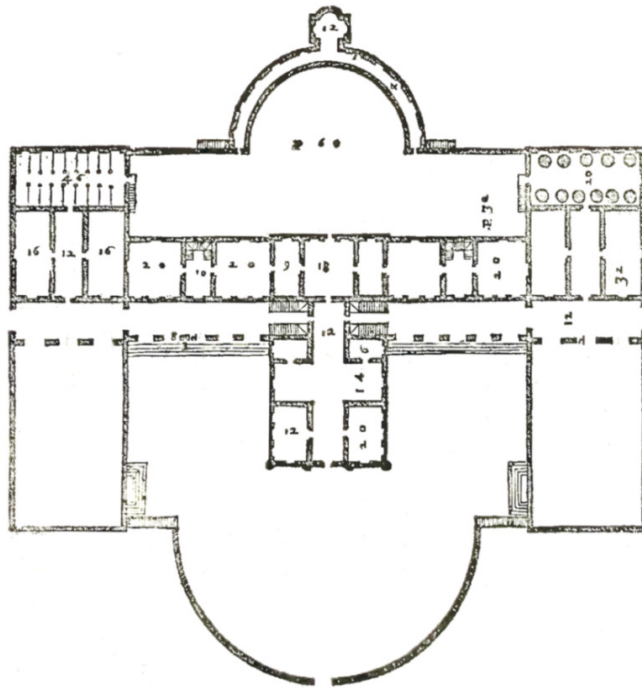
Planta da Villa Barbaro segundo Palladio (apud Wittkower).
